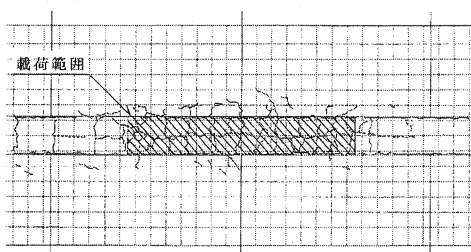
試験終了時接合部床版の下面ひび割れ発生状況
